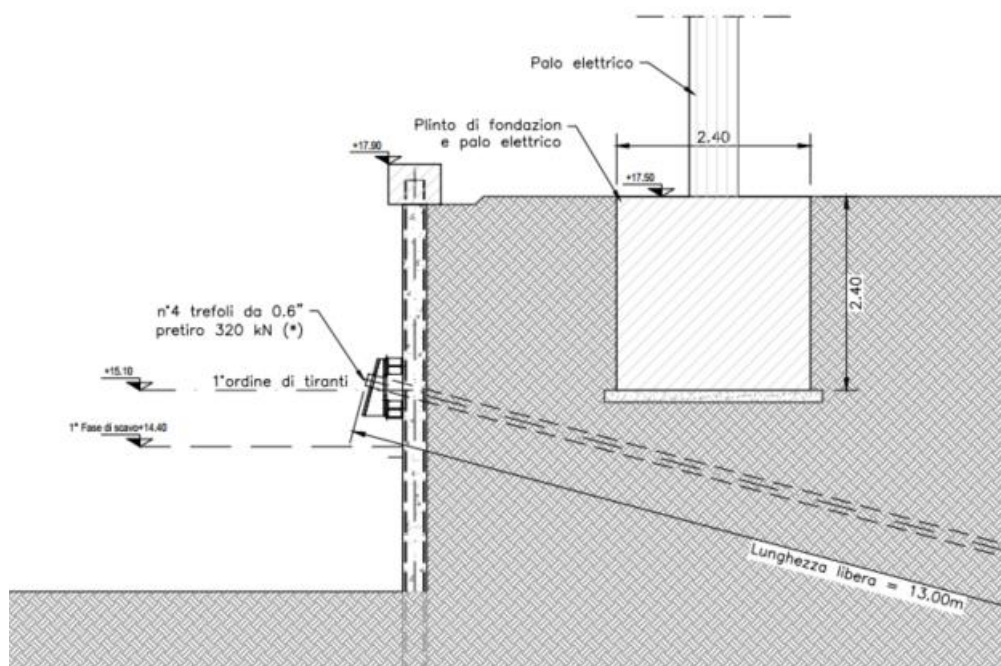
Sezione trasversale in corrispondenza della fondazione del palo elettrico
